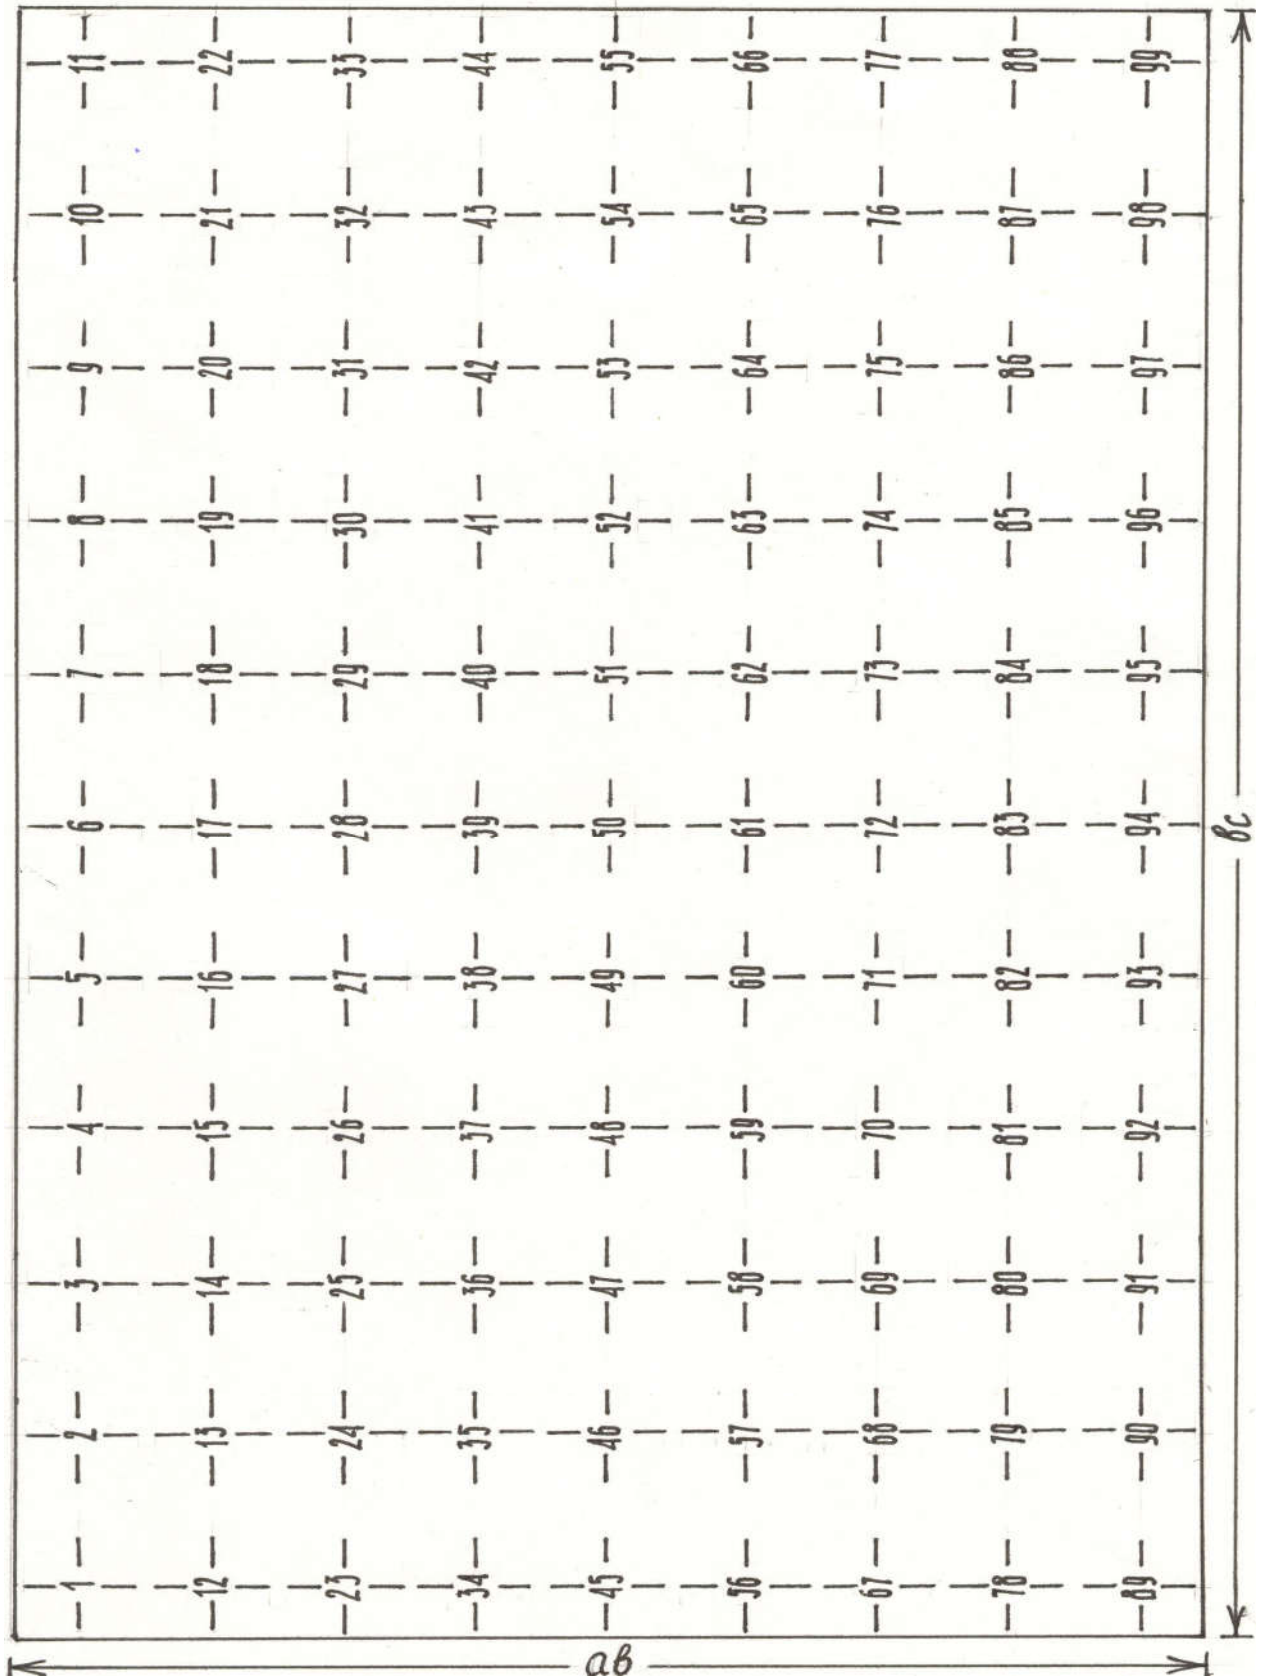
Схема размещения электродвигателей на плане помещения (цеха)
